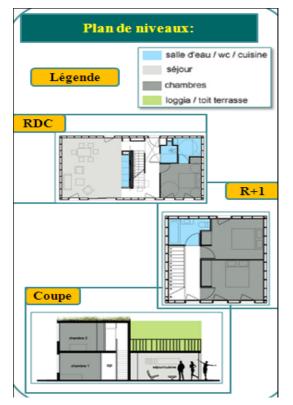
Plan RDC; R+1; coupe d'une unité du logement Individuel
